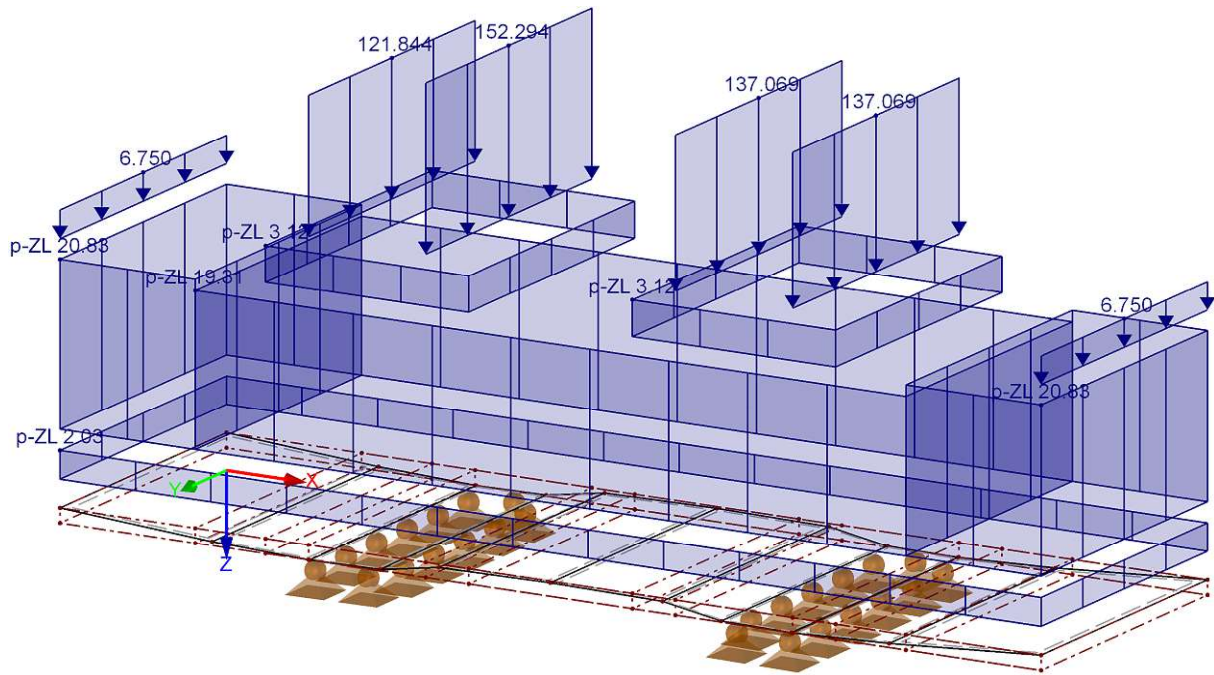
Bemessungslast des Betriebslastfall auf dem fertigen Quertragwerk.
